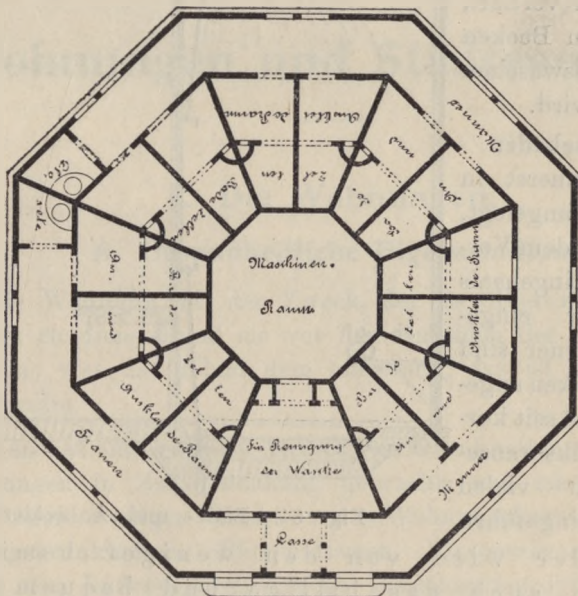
Grundriss des Frankfurter Volksbrausebades.
